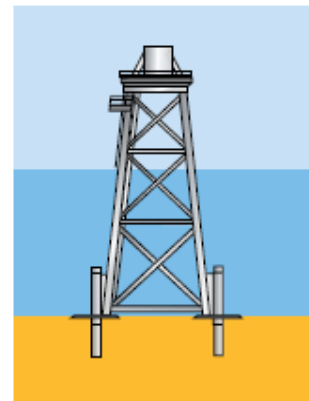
Cimentación tipo jacket. Fuente: EWEA
